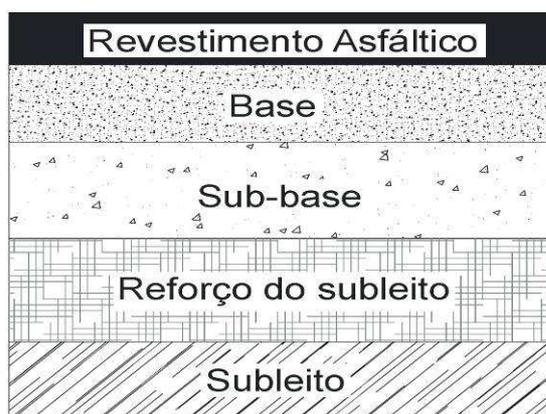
Esquema estrutural de um pavimento flexível.
